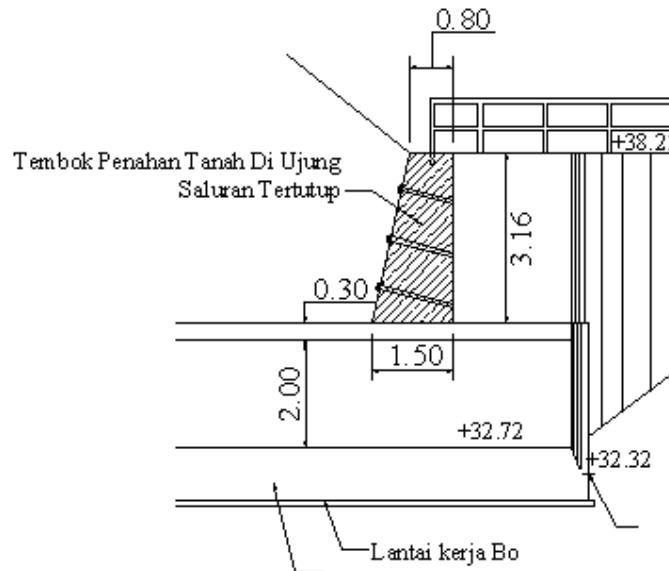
Tembok Penahan Banjir pada Bangunan Pintu Pengambilan Bendung
